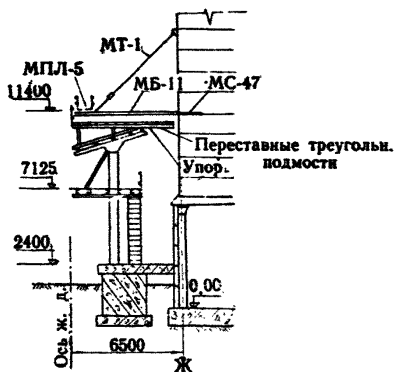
Схема монтажа конструкций устройств для отпуска зерна на железную дорогу
